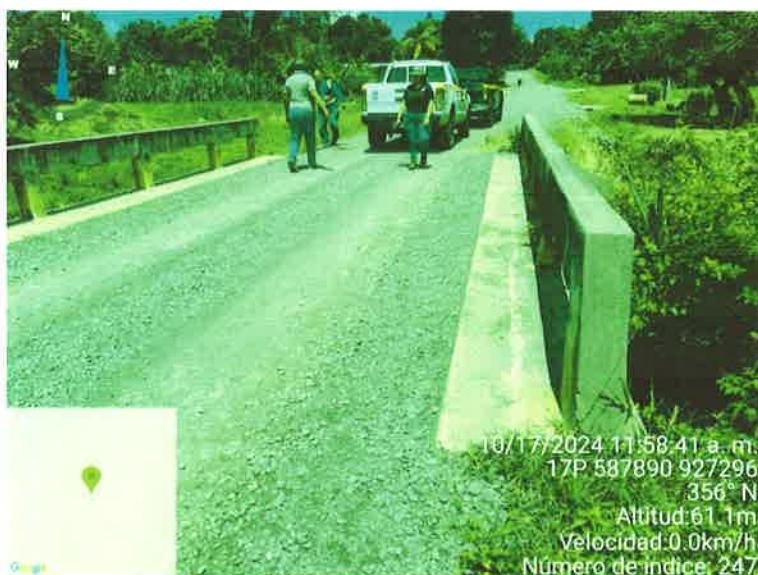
Fuente hídrica N°5, identificada como quebrada Santa Rita, con construcción, ubicada en las coordenada UTM WGS 84: 587781 E // 940026 N.
